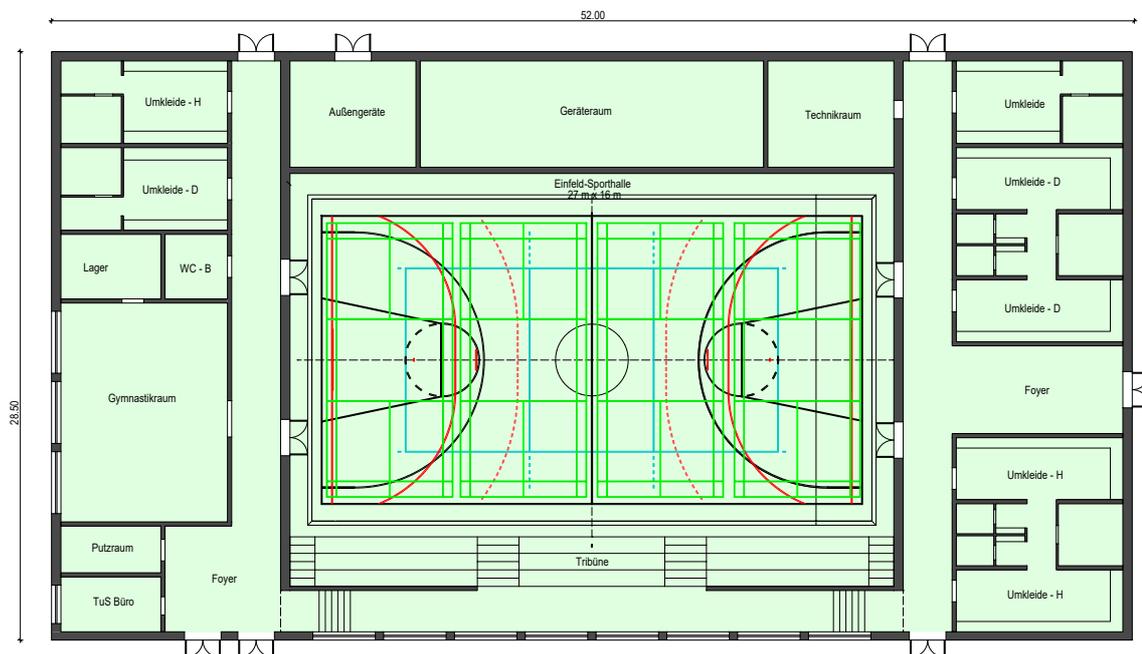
Grundriss Sporthalle Neubau (ohne Maßstab)
